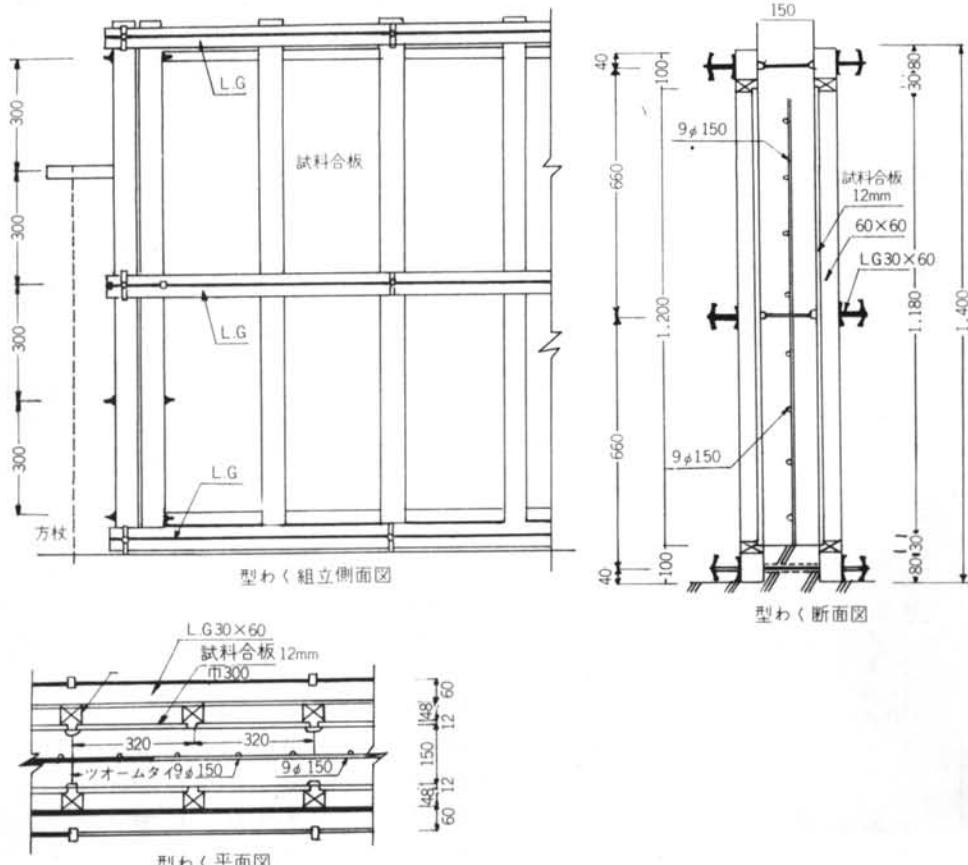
コンクリート打込み用型わくの組立ておよび配筋図
